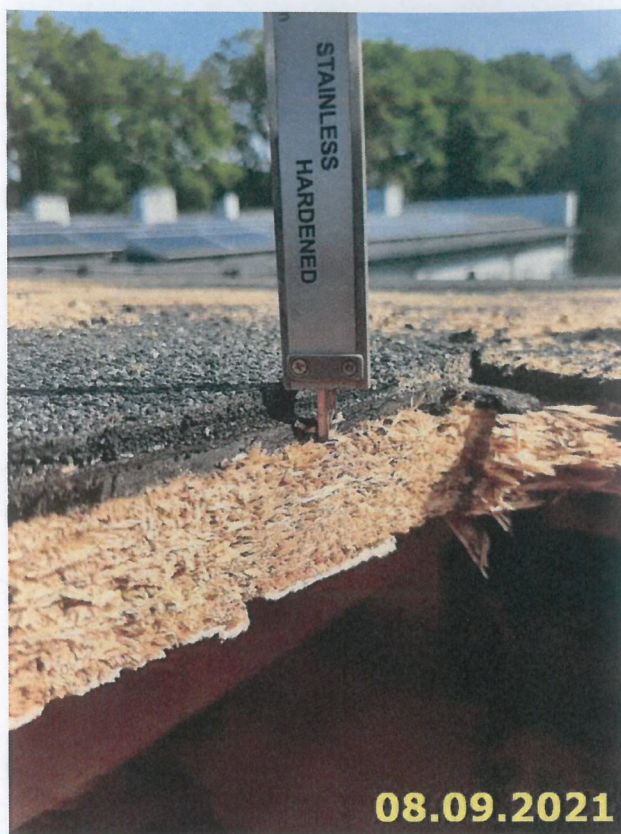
Odkrywka – detal warstw pokrycia dachu. Widoczne : płyta OSB FIRESTOP, papa podkładowa na lepiku, papa wierzchniego krycia.
